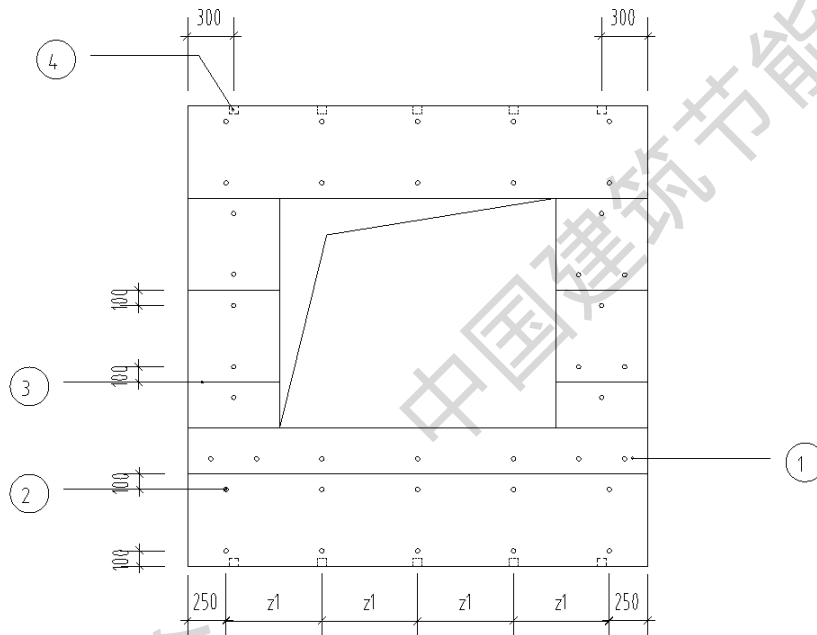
蒸压加气混凝土装饰板排板示意图
